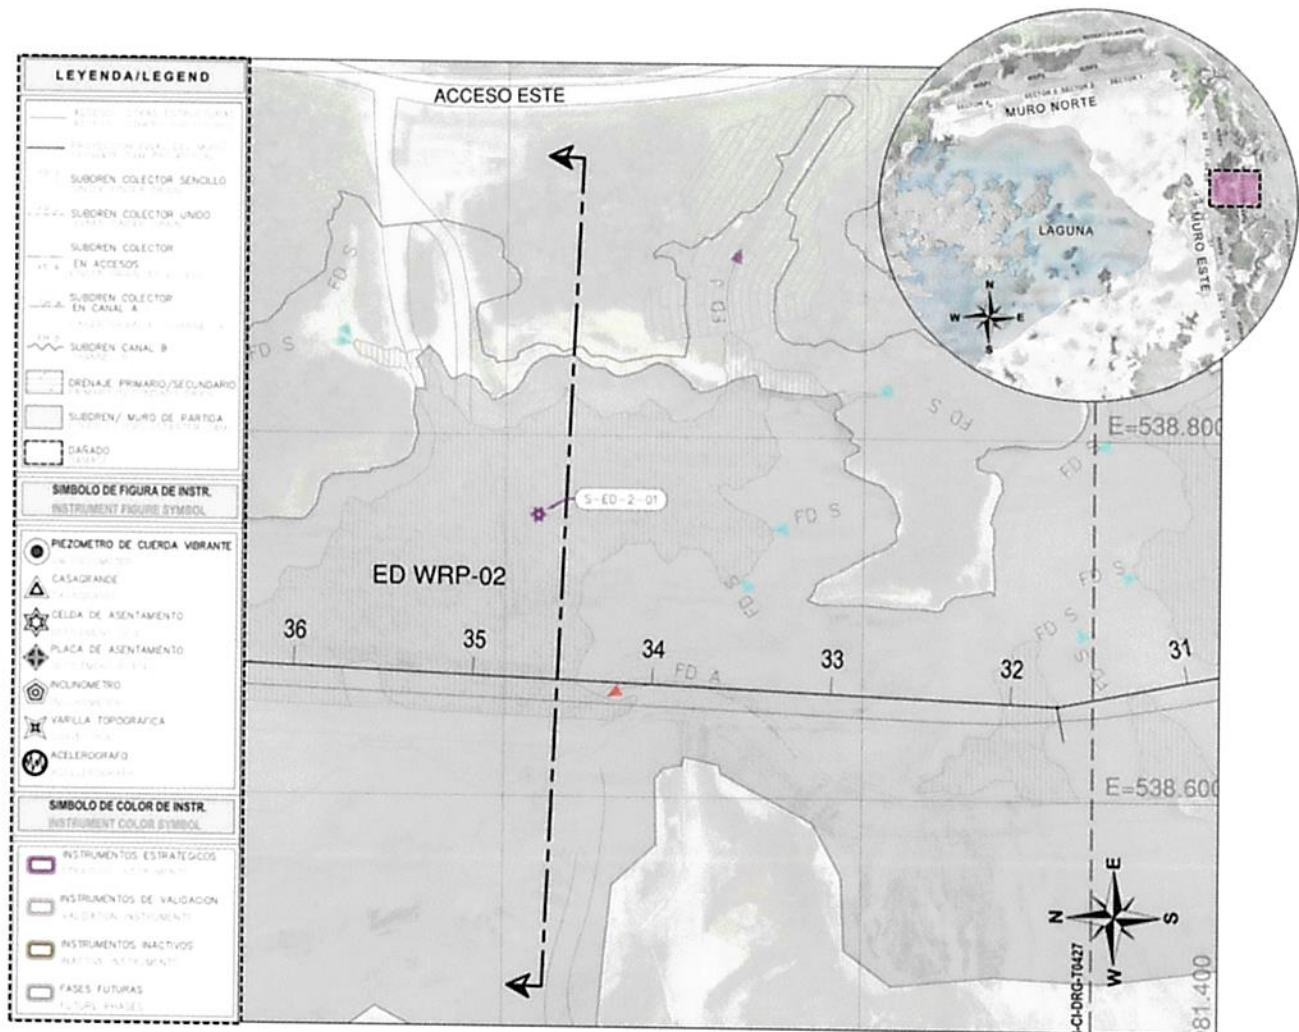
Vista de Planta en el Muro Este WRP2 con las Celdas de Asentamiento
